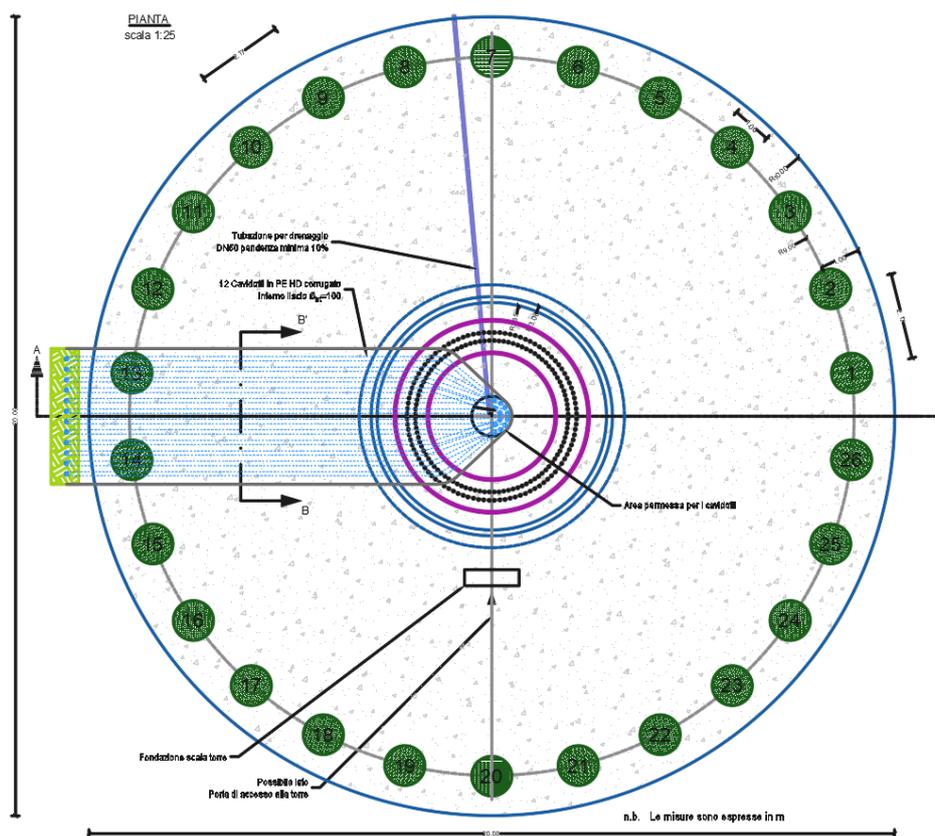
Pianta del plinto con indicazione dei pali di fondazione da 100 cm
